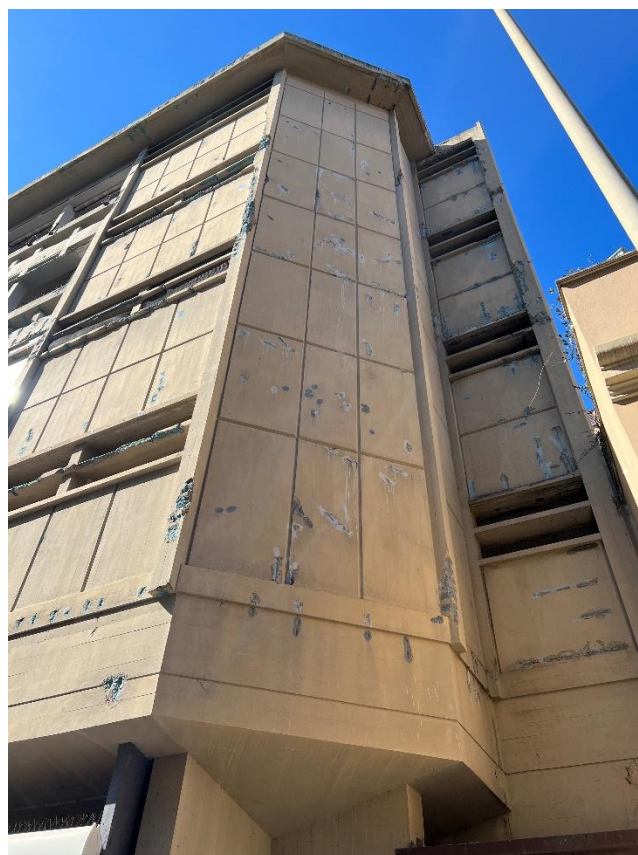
Figura 55 – Degrado sul prospetto nord-est
